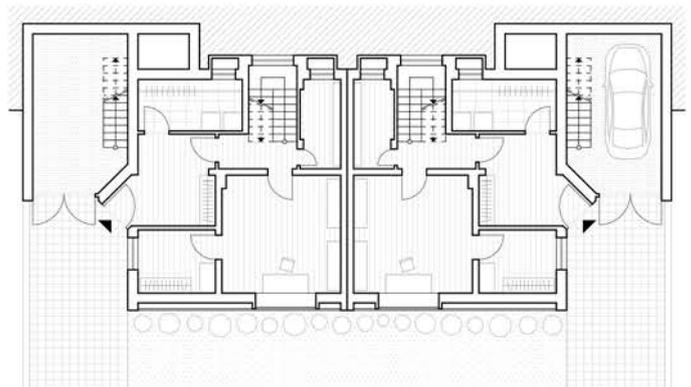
Grundriss Untergeschoss M 1:200
